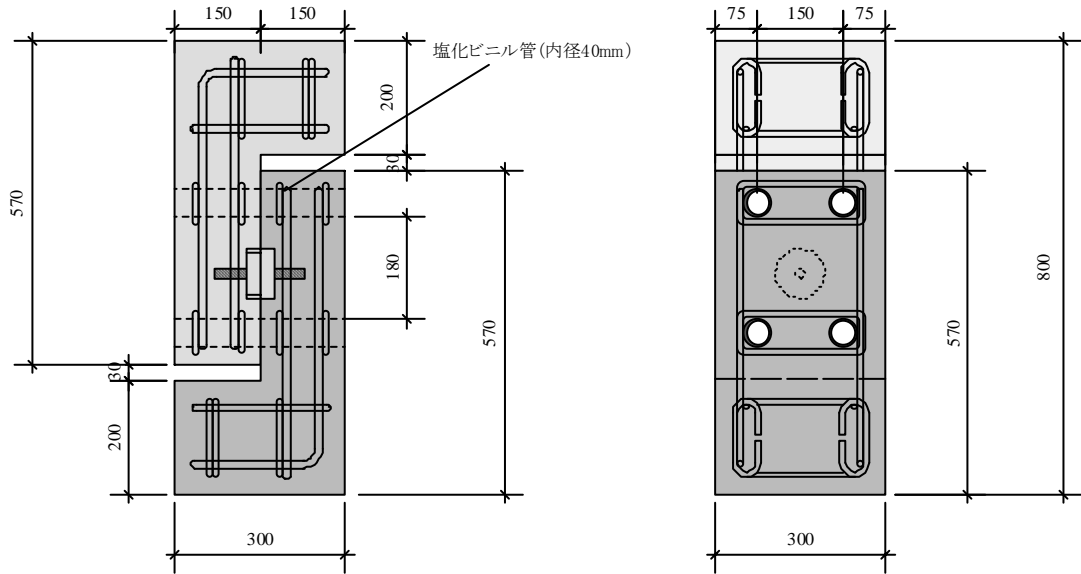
ディスク型あと施工アンカーのせん断試験体図 (単位 : mm)
